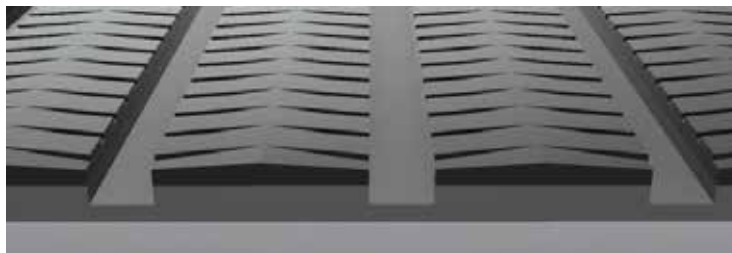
Planbefestigter Rillenboden mit Profil (© KTBL)
